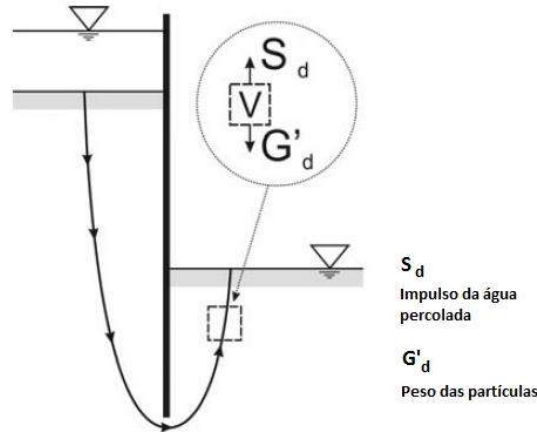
Ilustração esquemática do fenómeno de levantamento hidráulico no interior de uma escavação (adaptada de Wudtke, R. B. (2008)).
